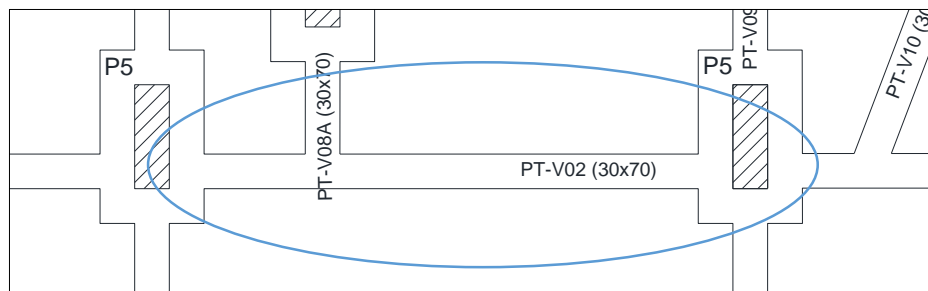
Planta de encofrado de con tramos de vigas a diseñar
